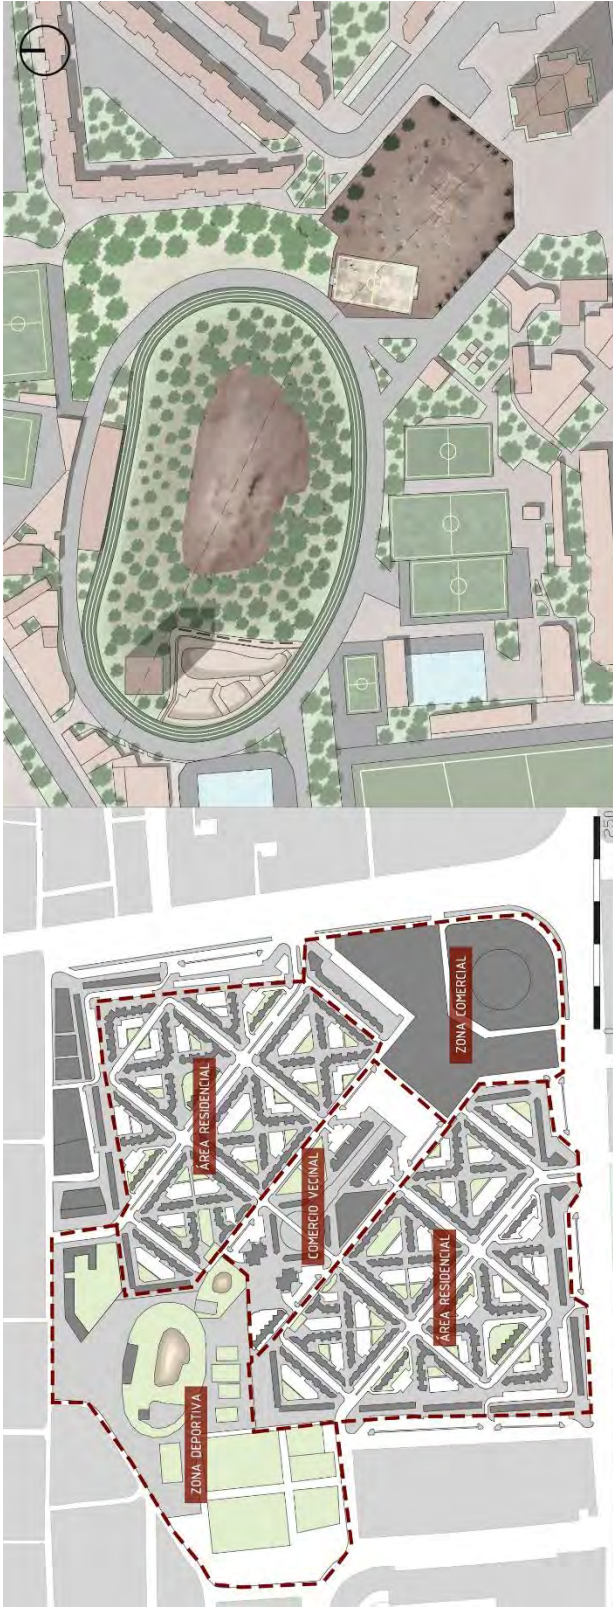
Planta y Corte de Huacas La Calera I y II y Conjunto Torres de Limatambo. Elaborado en base de Google Earth y levantamiento propio.
